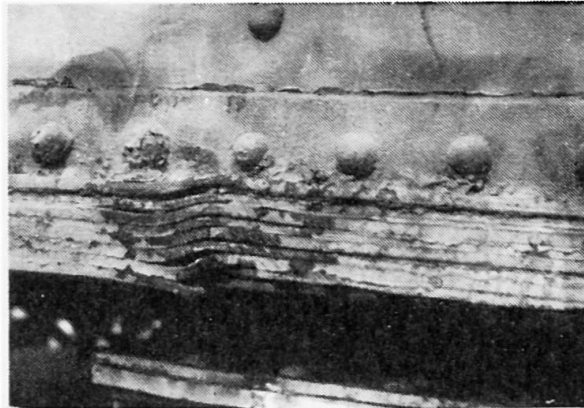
Beschädigter Untergurt einer Eisenbahnbrücke
